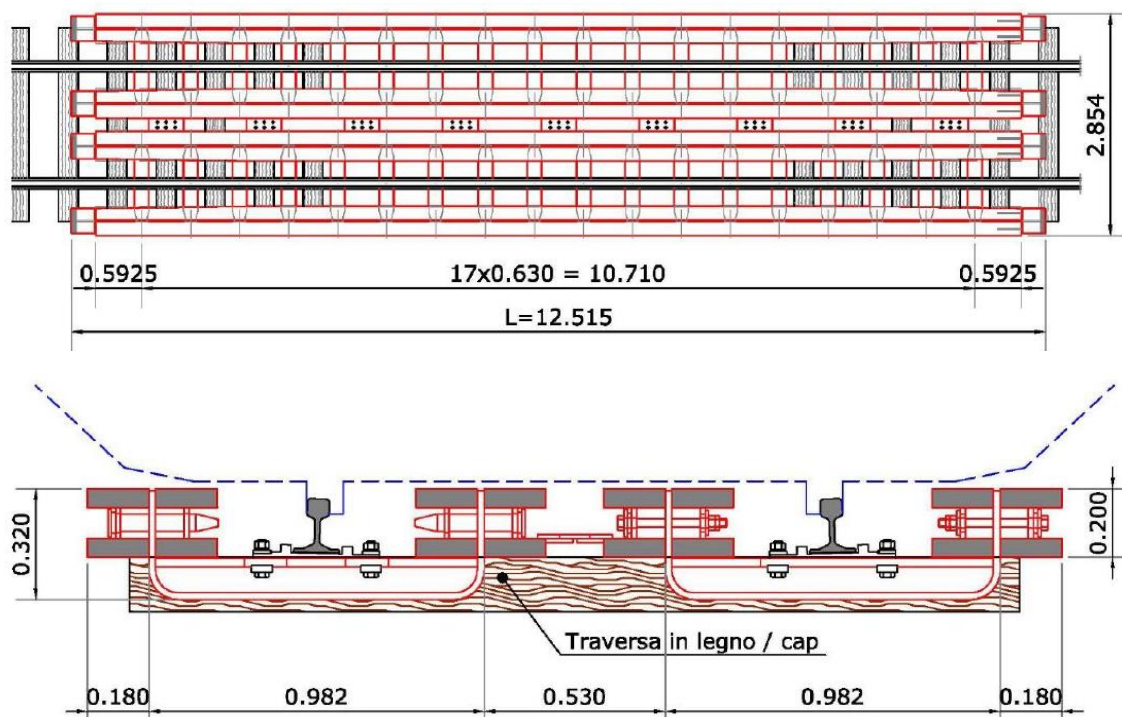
Sistema di sostegno provvisorio “Ponte Essen” – pianta e sezione trasversale (MdP P.II sez.2)
